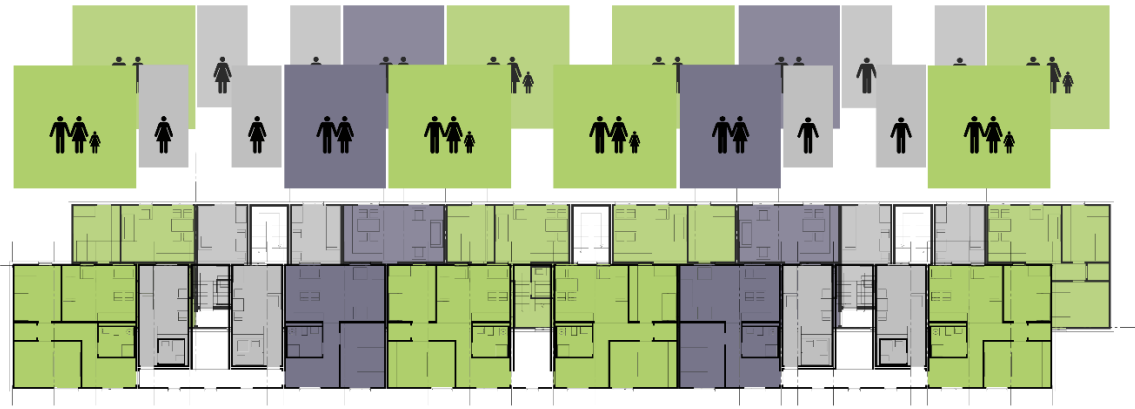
Grundriss eines Riegelbaus (aufgestockter Bereich)
